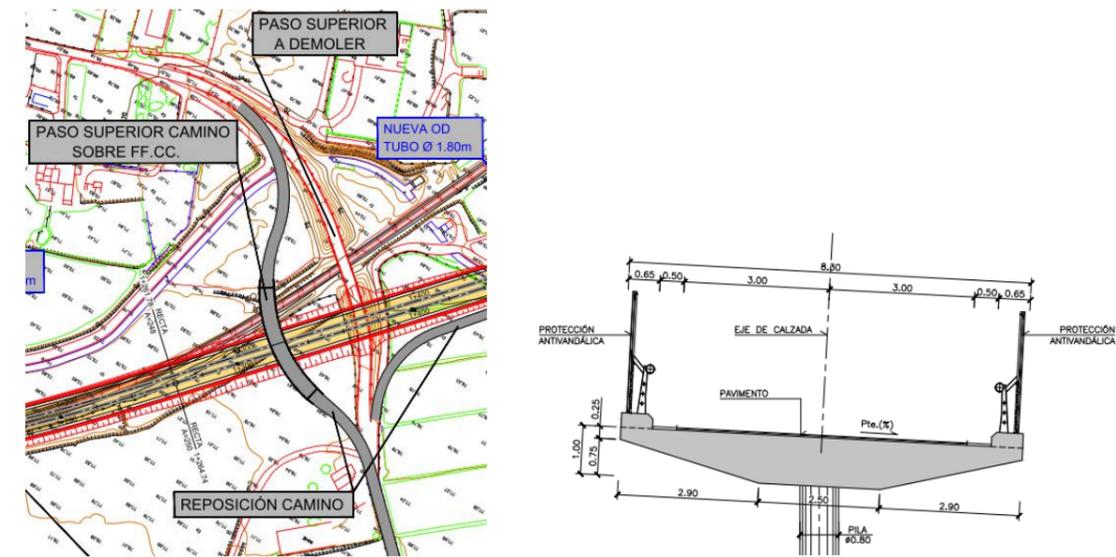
PS 1+325. REPOSICIÓN PLANTEADA
